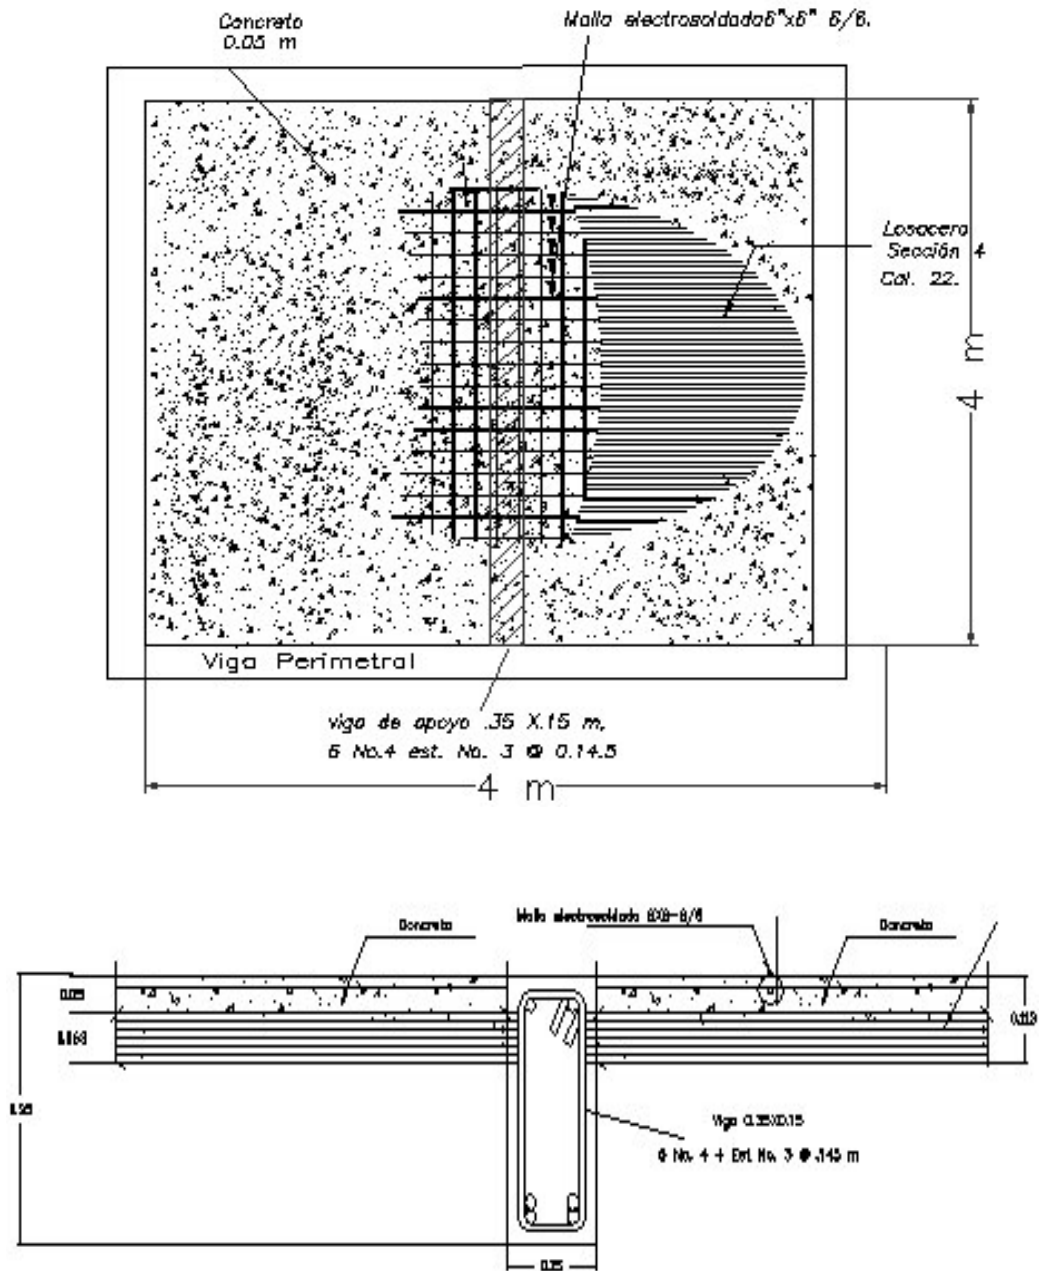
Detalle de losa-acero utilizada en la losa de 4 x 4 m
